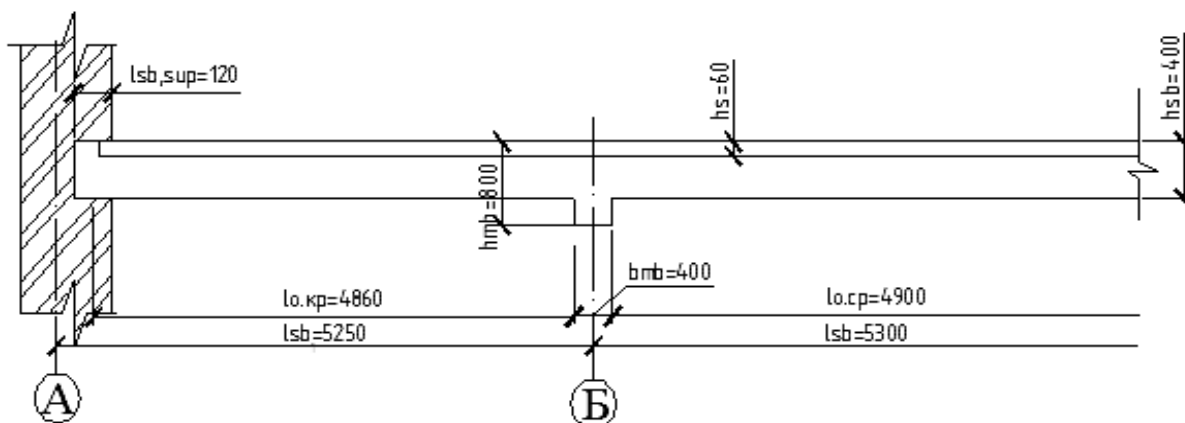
К определению расчетных пролетов второстепенной балки
